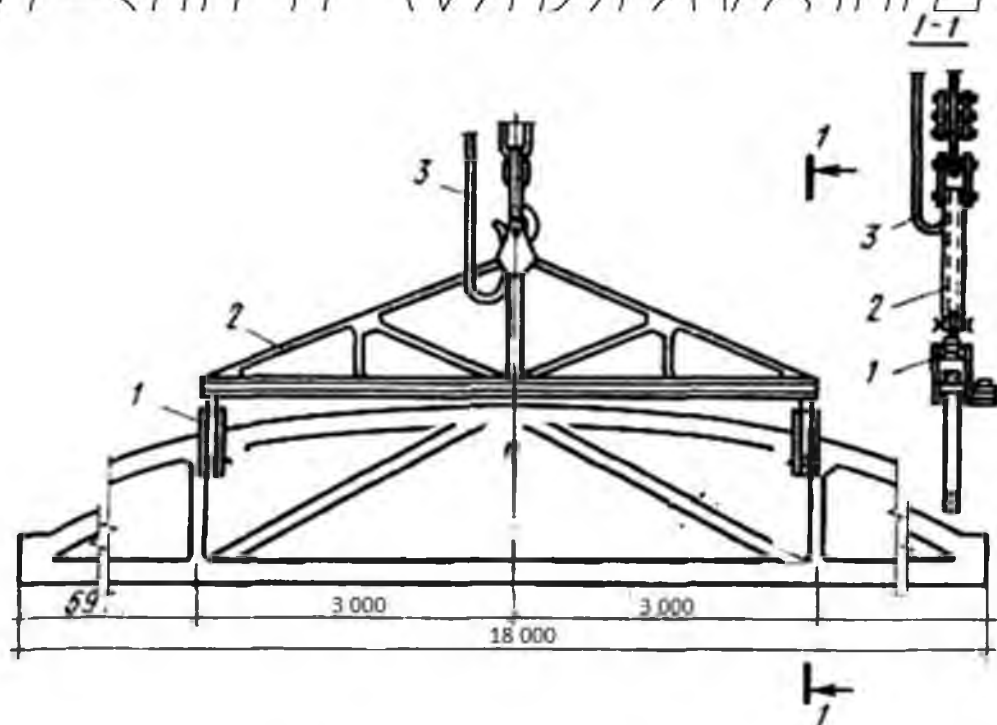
Напівавтоматичний захватний пристрій для монтажу залізобетонних арок: 1- захват; 2 - жорстка траверса; 3 – кабель
